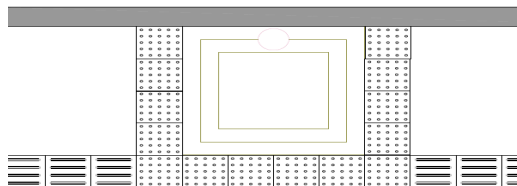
Objeto suspenso com sinalização tátil visual em planta
